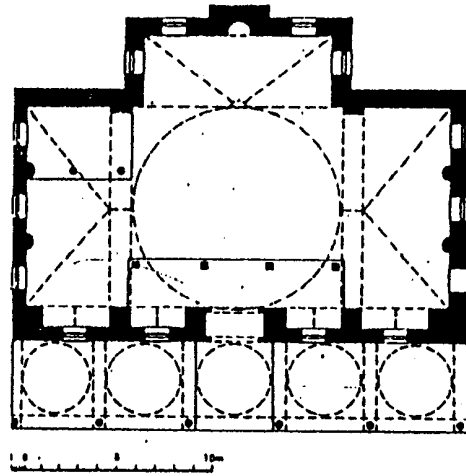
مسقط أفقي لجامع السلطان بايزيد في اماسيا
